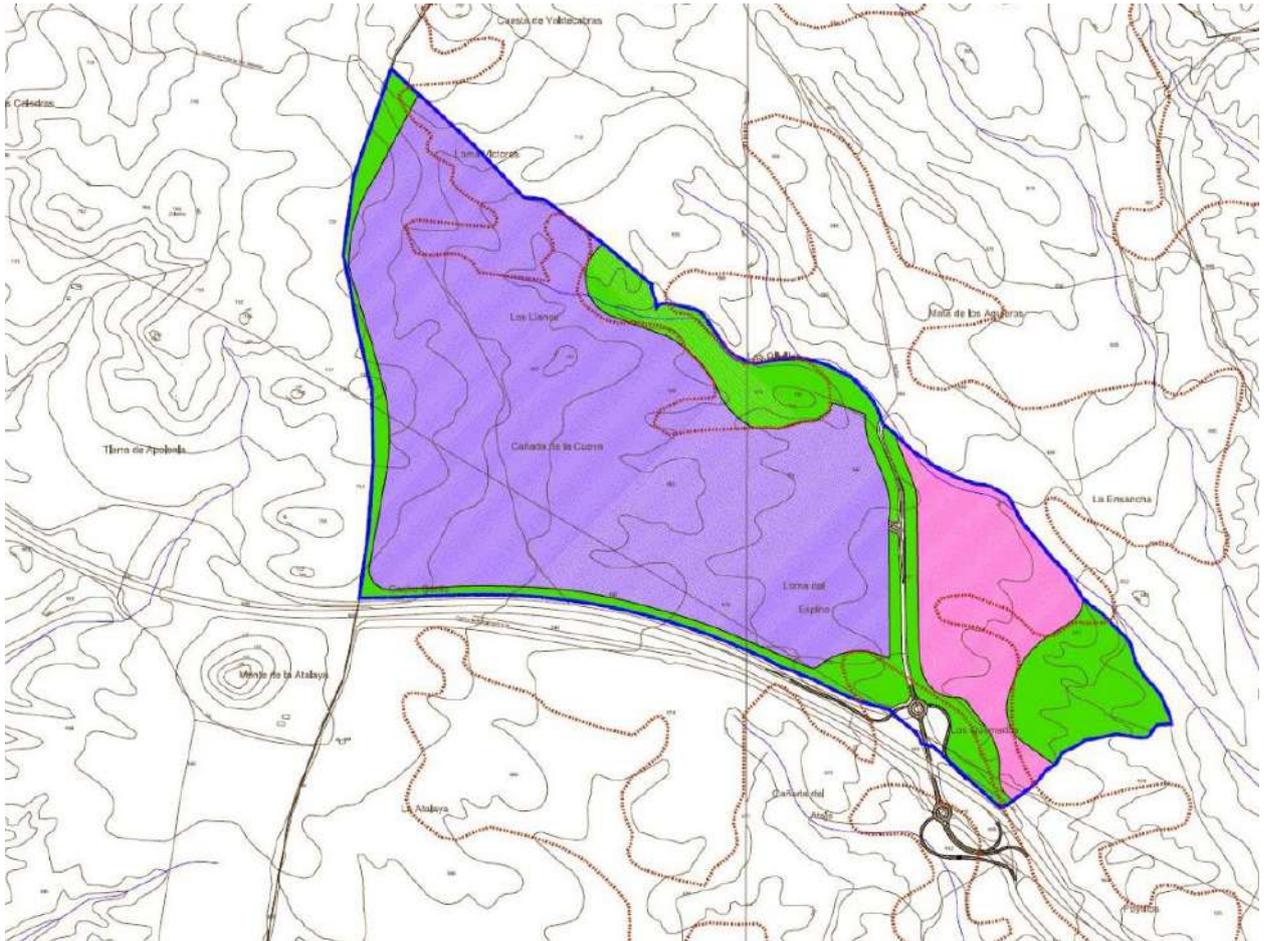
Plano de ordenación posible, Alternativa 1 (Fuente: C+LL).
